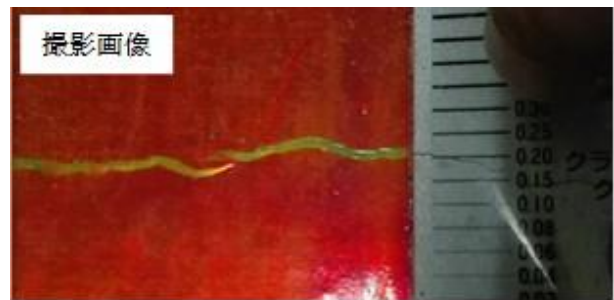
処理ソフトを使用した際のひび割れ可視化
